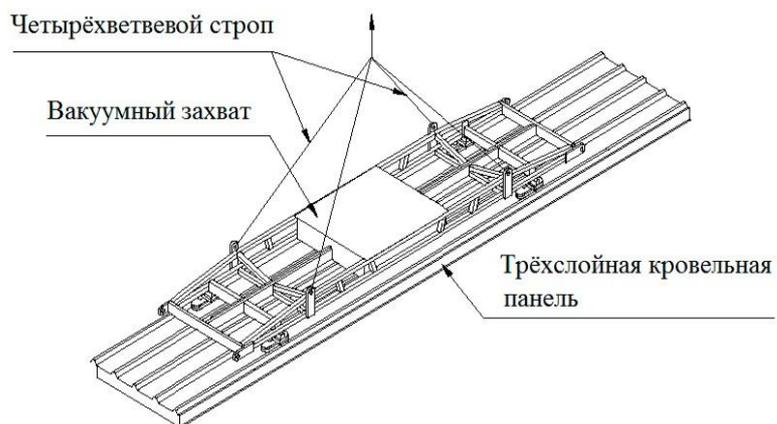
Схема монтажа кровельных сэндвич-панелей
